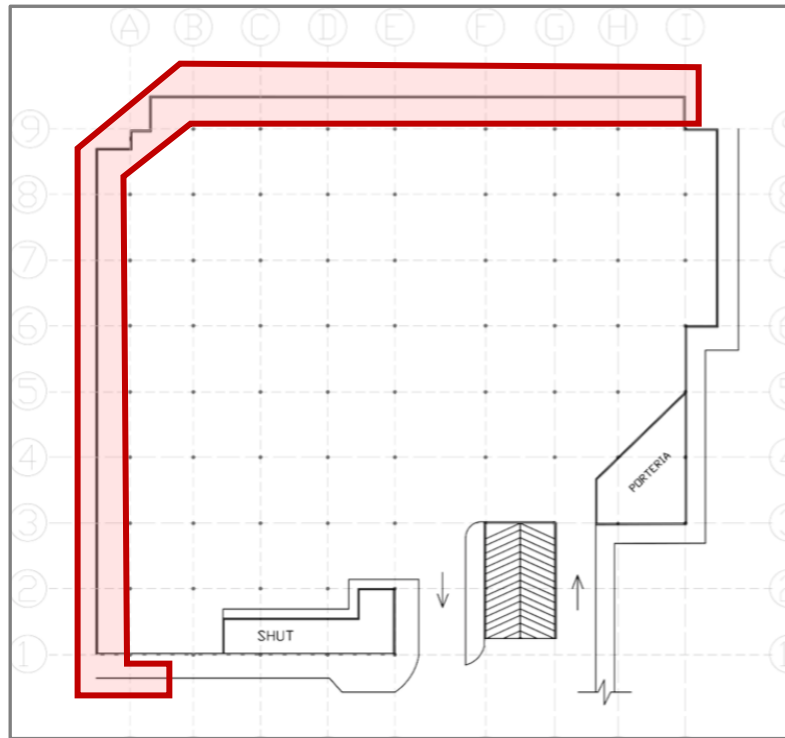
Planta de primer piso, área muros intervenidos. Fuente: elaboración propia.
